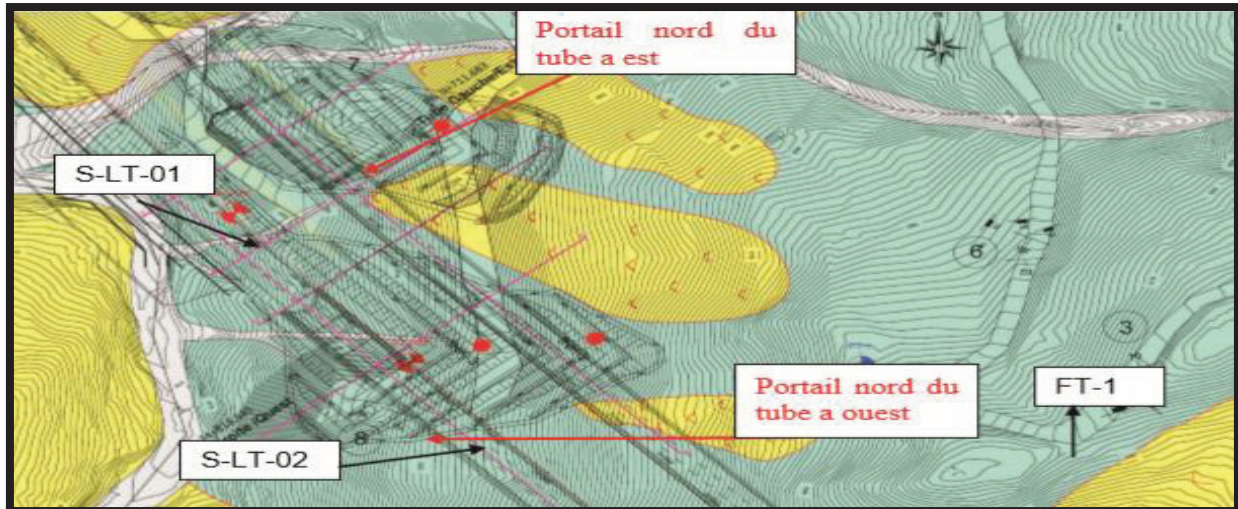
Plan d'installation du sondage situé sur la section du Portail Nord
